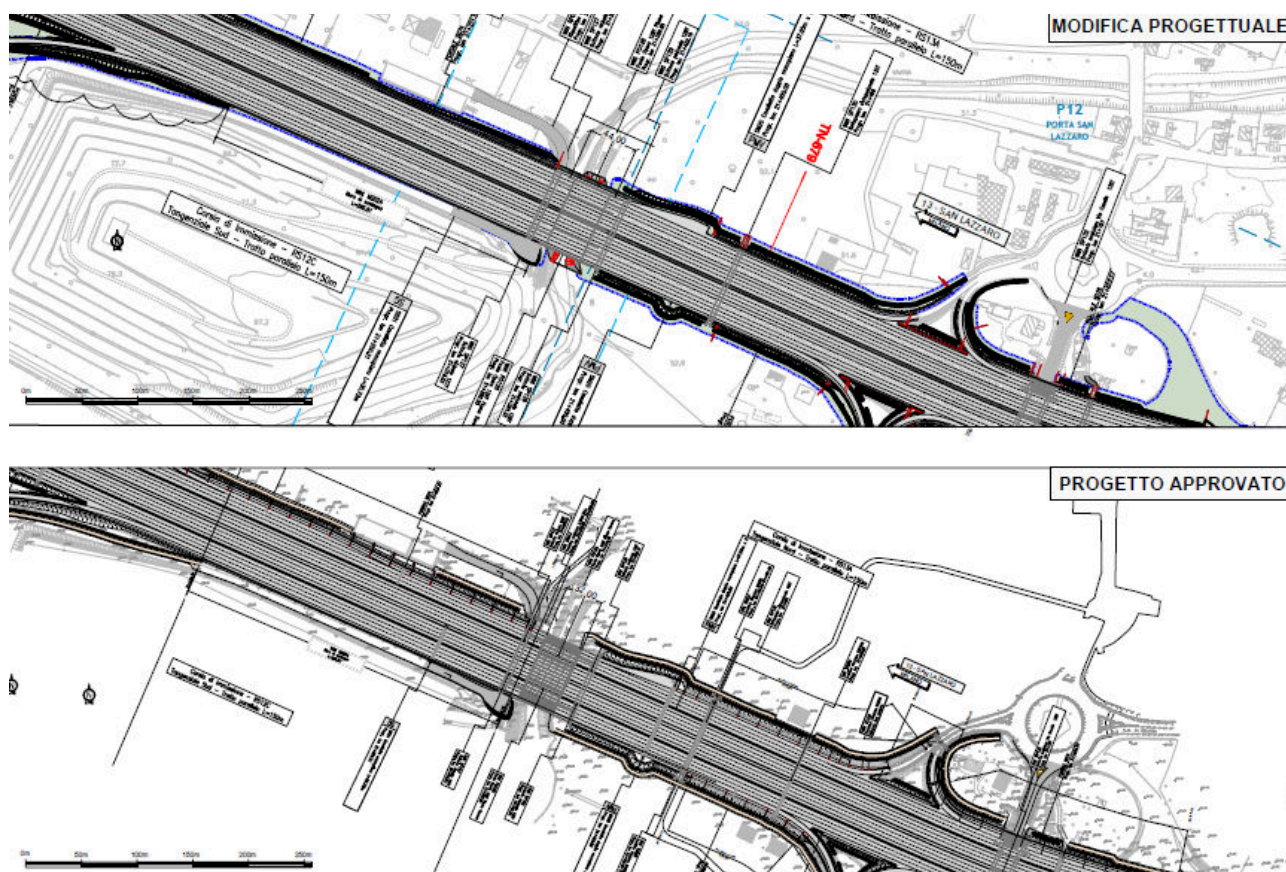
Planimetria di raffronto tra progetto di ampliamento e progetto di demolizione e ricostruzione (Fonte: Tavola 3)
